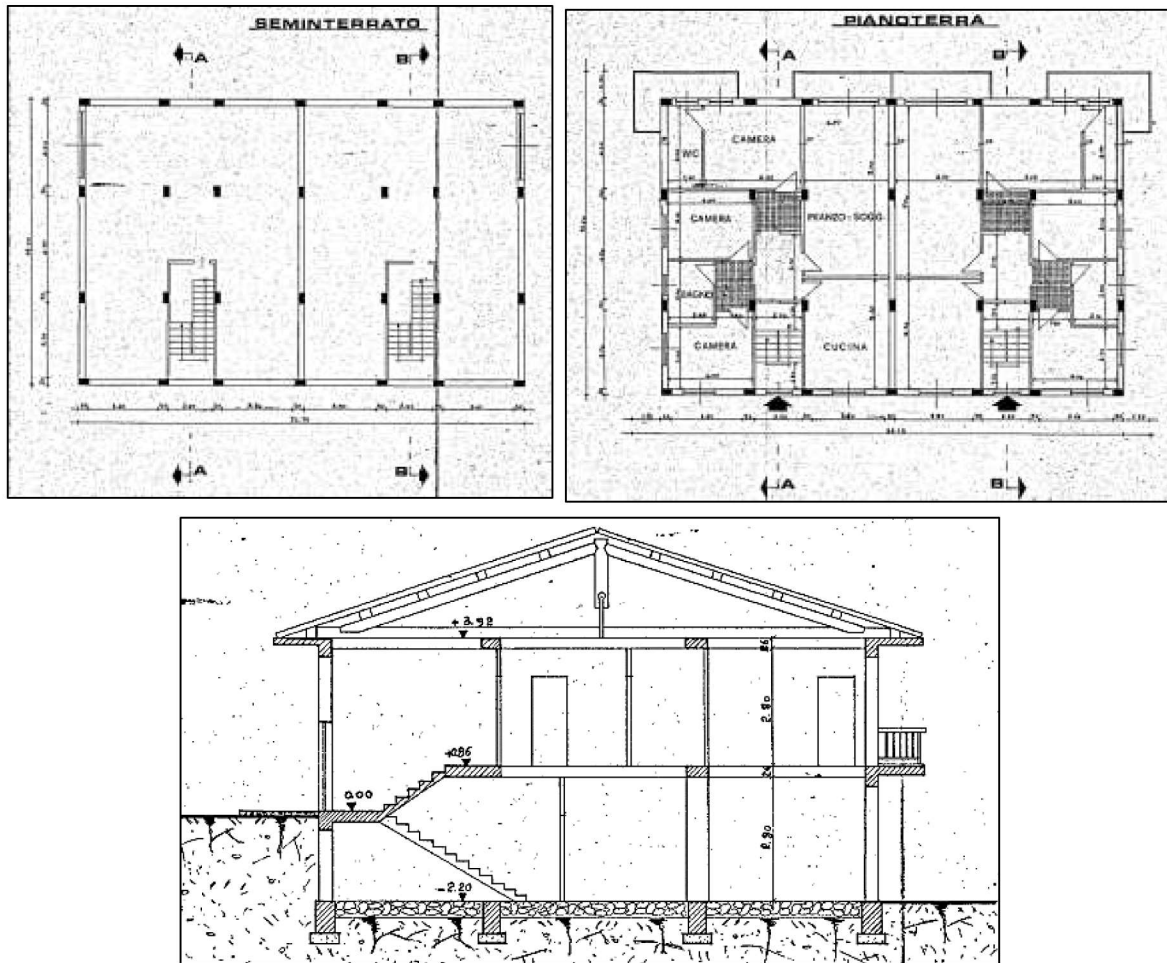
Planimetrie e sezione livelli di piano – Elaborati grafici Concessione Edilizia n.52 del 16/10/1982
